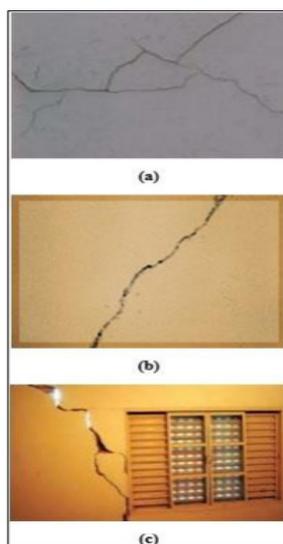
a) fissura, b) trinca, c) rachadura.
